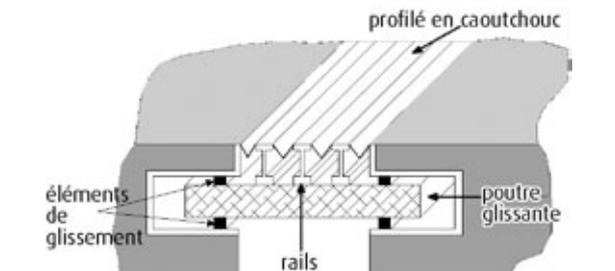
Schéma d'un joint modulaire à poutres glissantes
